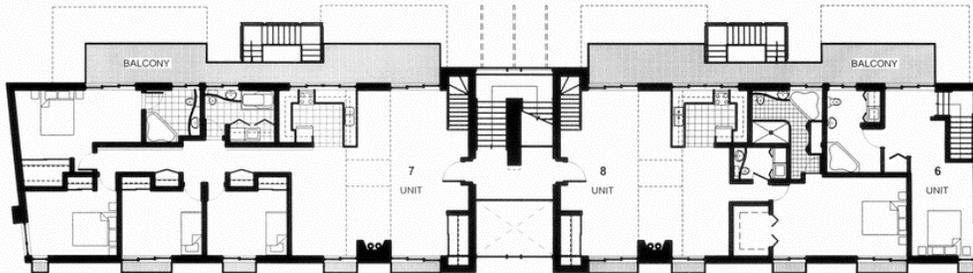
WINDHAU, Plans du 3^{ème} étage (Source: INDESIGN, 2007).
